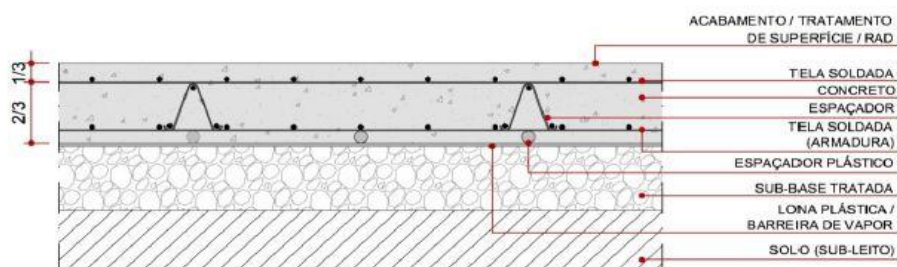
Pavimento com armadura distribuída descontinuamente [Carvalho, (2009)]
